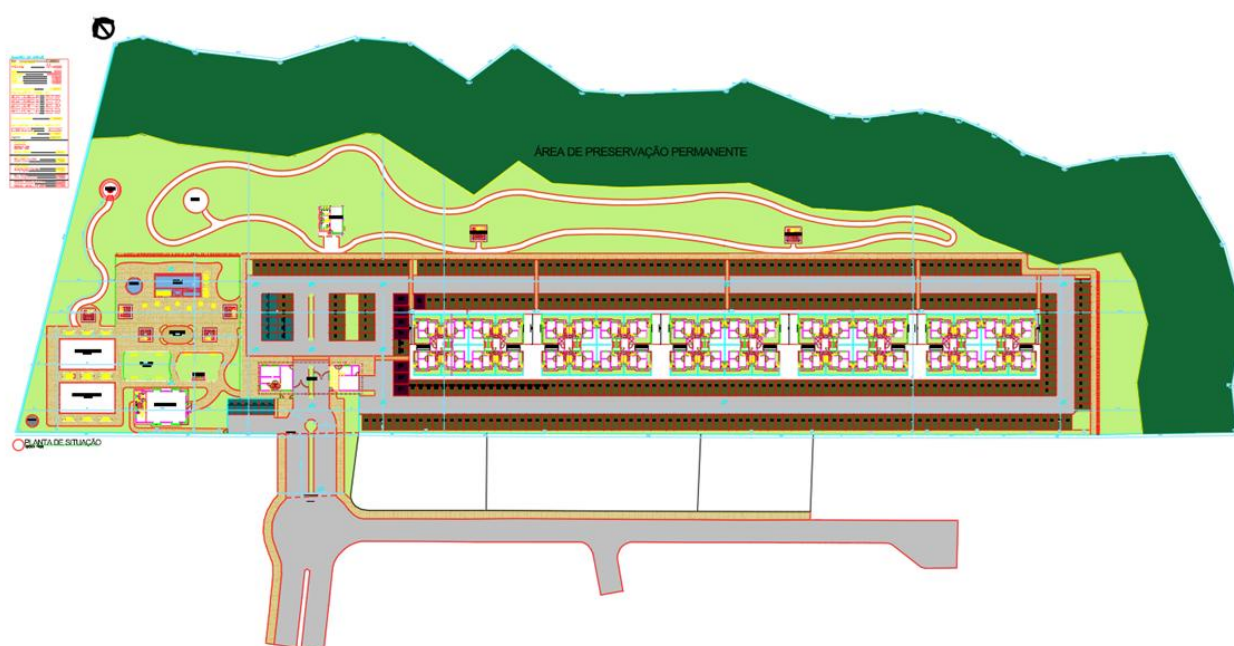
Planta de Implantação. Fonte: LM5 Construtora.
